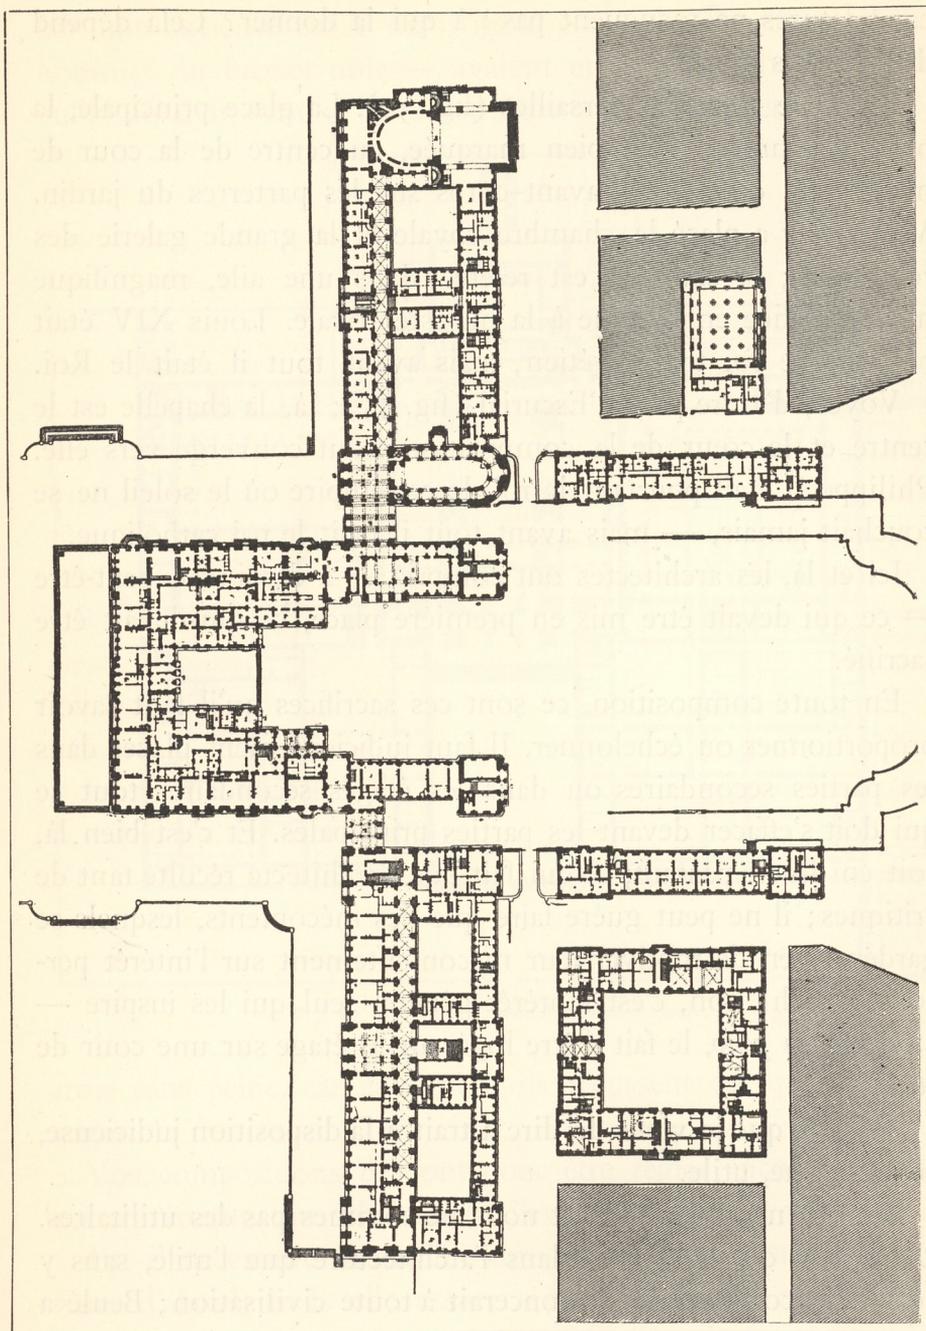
Palais de Versailles. Plan du rez-de-chaussée.
